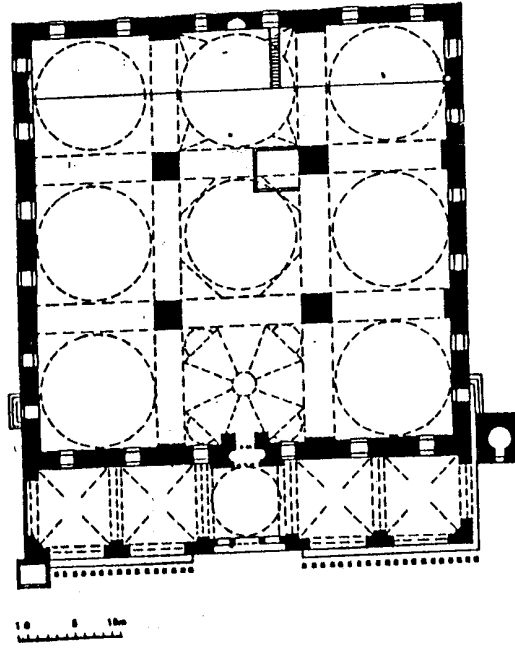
مسقط أفقي لجامع أحمد باشا القره مانلي بطرابلس الغرب
